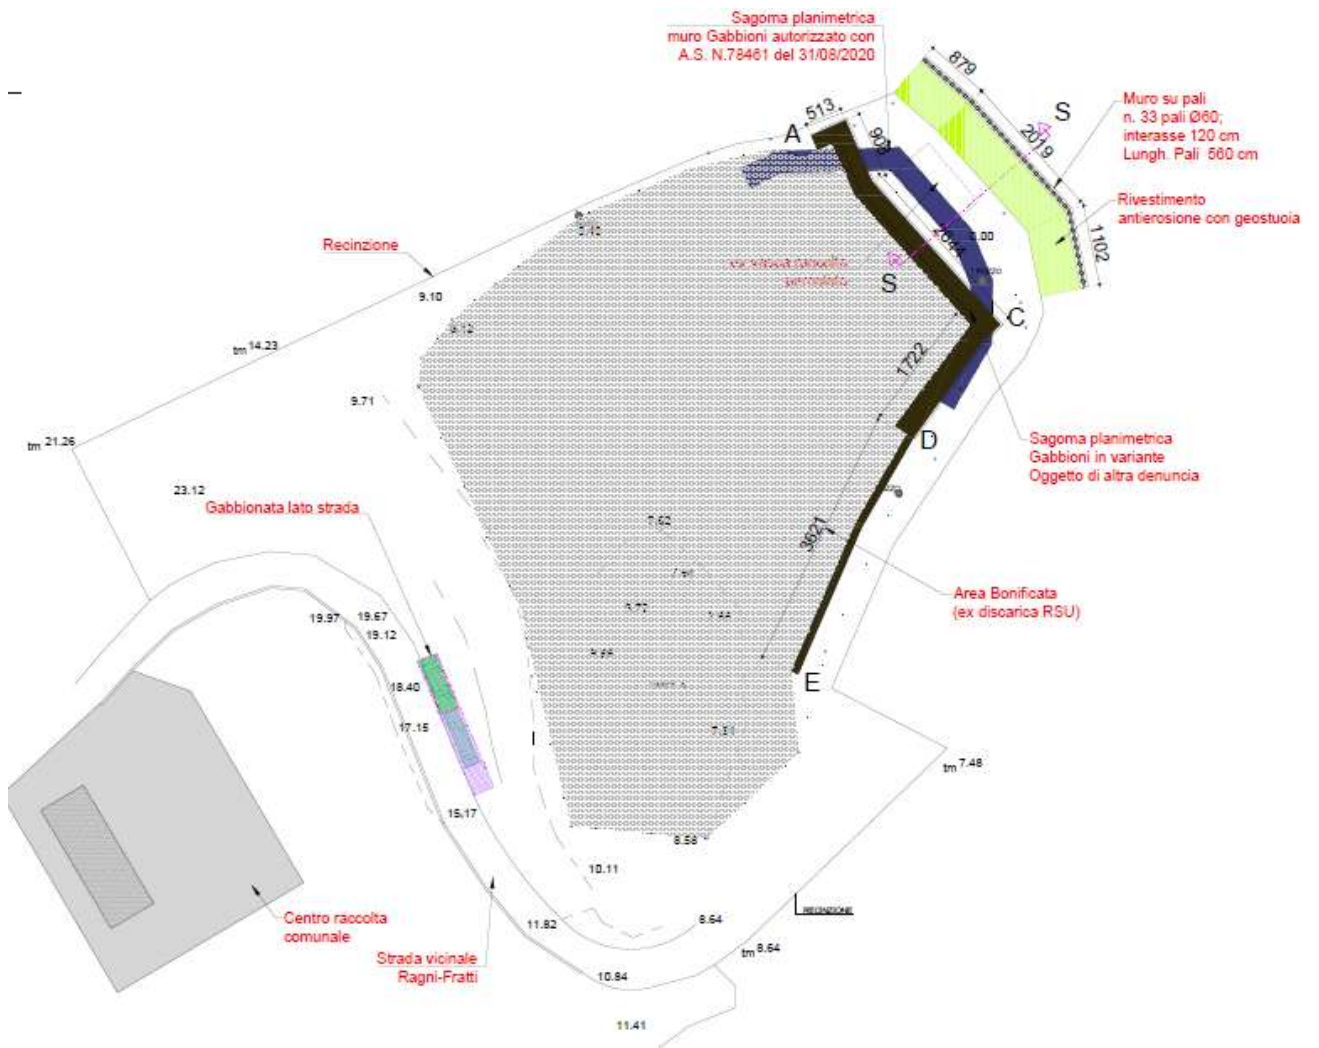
Planimetria generale dell'area, con sviluppo del muro in progetto
